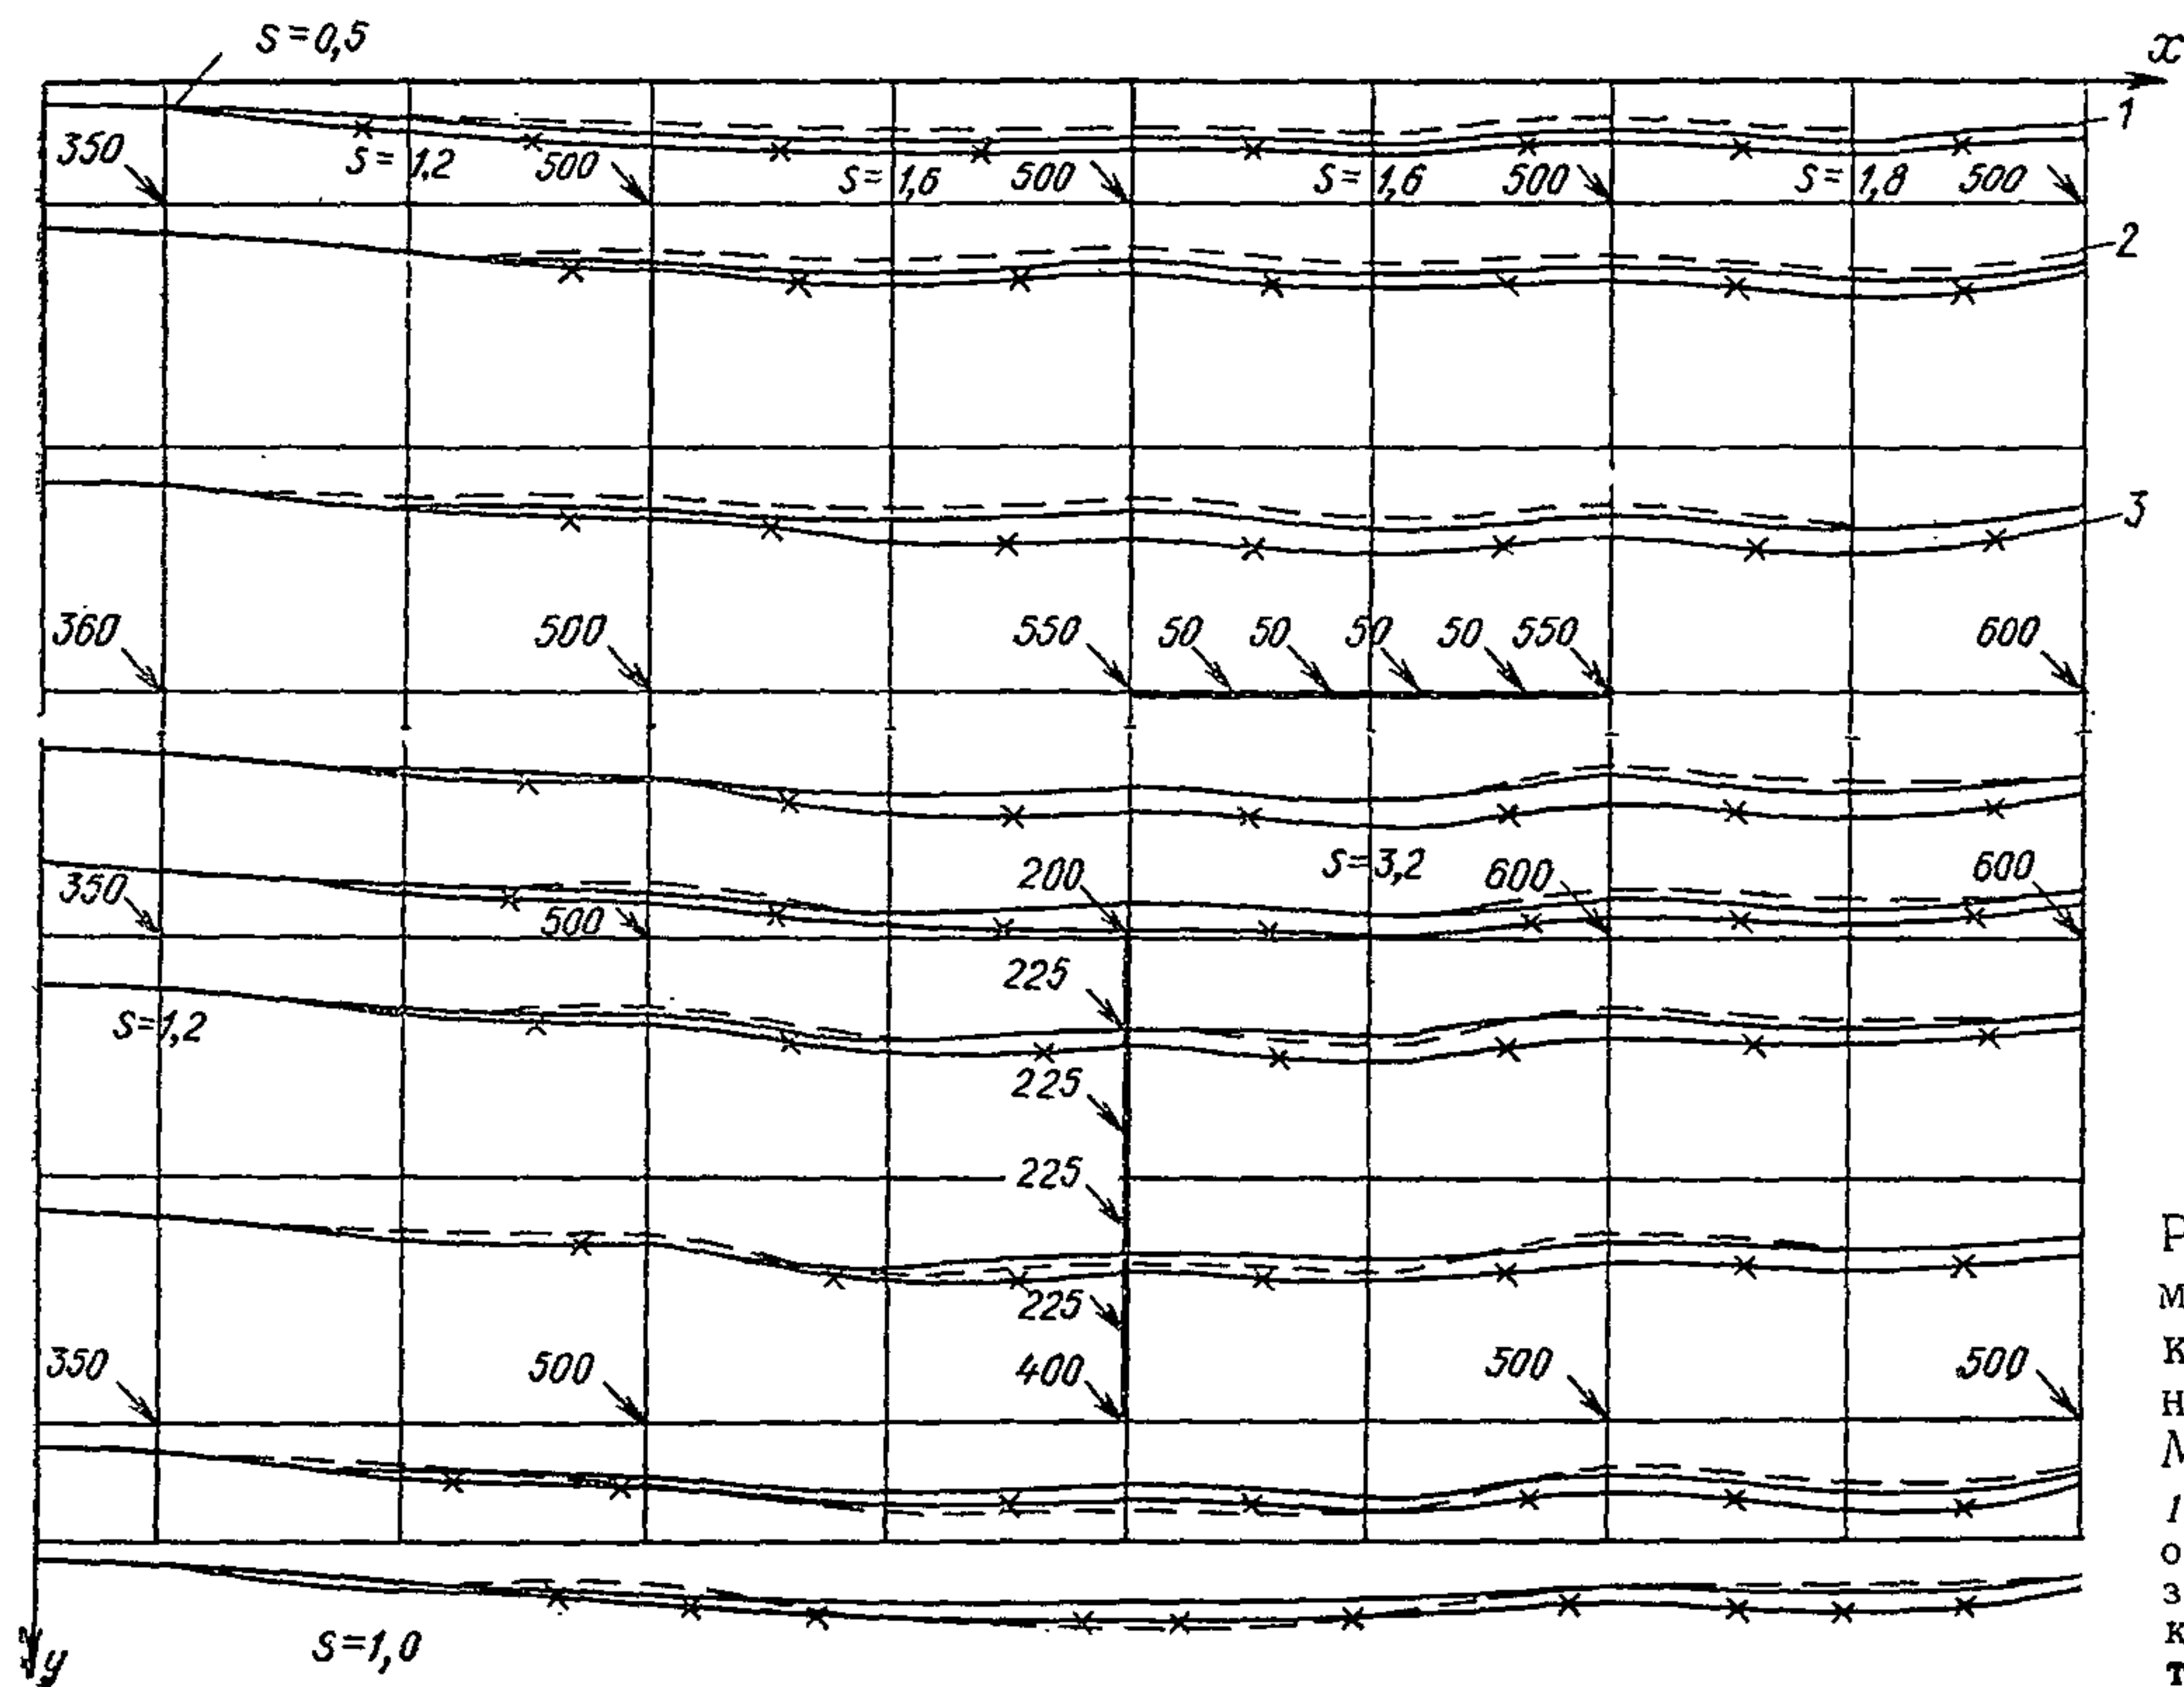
Осадки S , см, фундаментной плиты 16-этажного каркасного здания, полученные на ЭВМ М-220М по программе МРП-3
